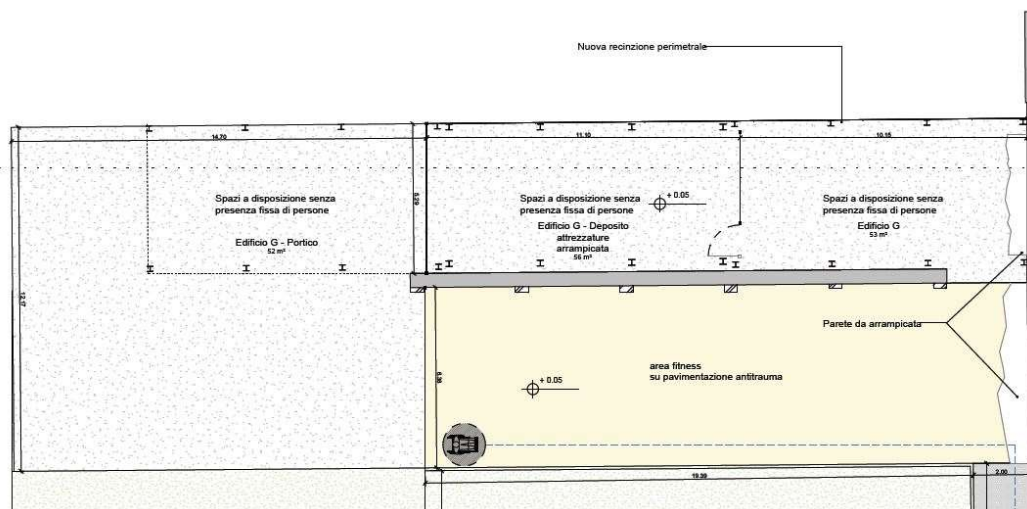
Ex-Galoppatoio - pianta piano terra Edificio 2
